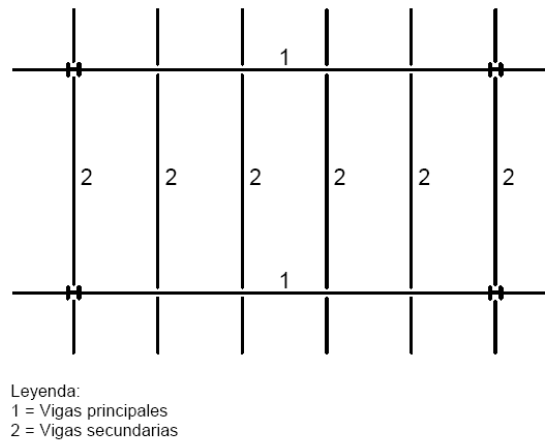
Disposición de vigas en una distribución rectangular; vigas secundarias más cortas.
